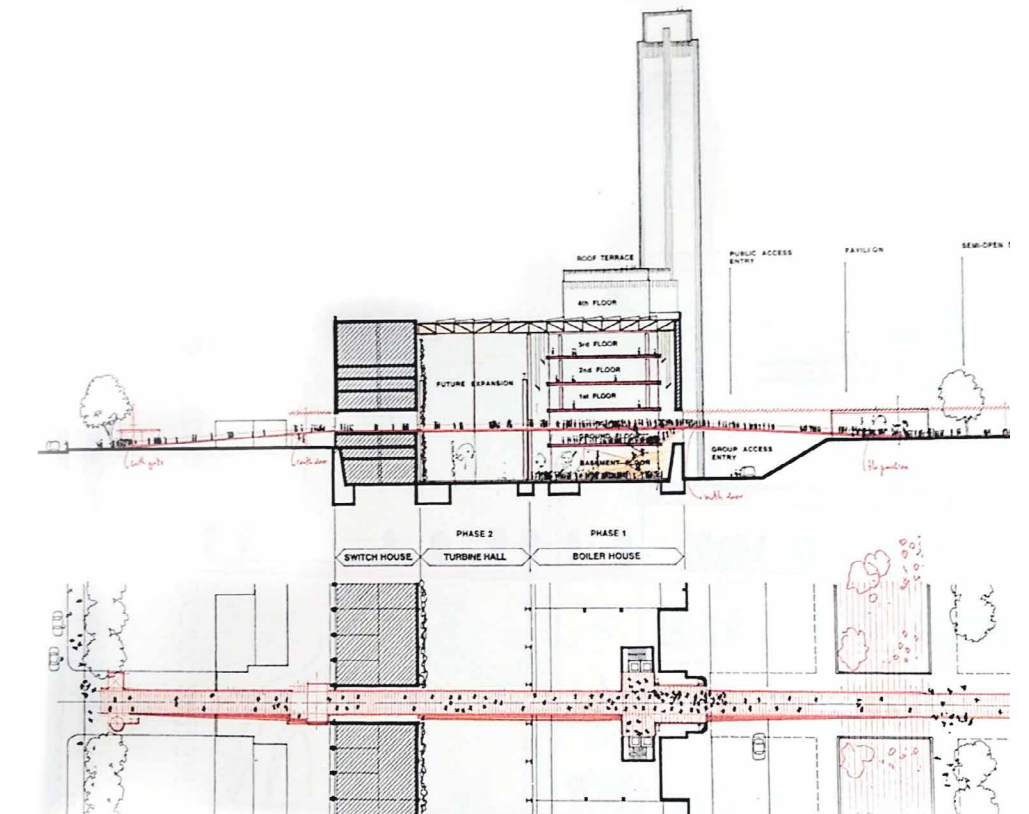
Sección transversal de proyecto (superior), y un fragmento de la planta general correspondiente al pasaje (inferior)
